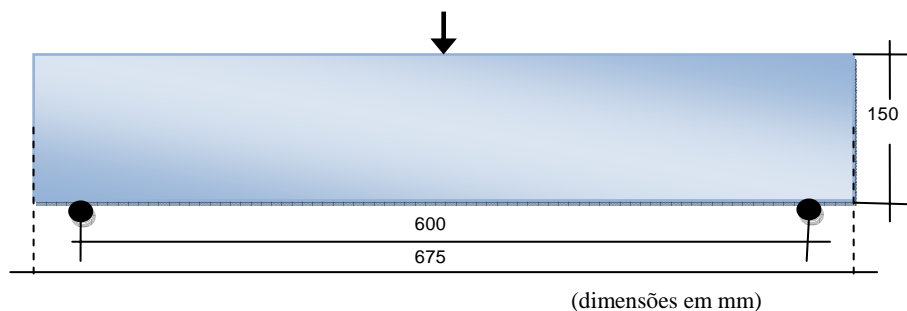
Vista longitudinal da viga com dimensões e condições de carregamento.
